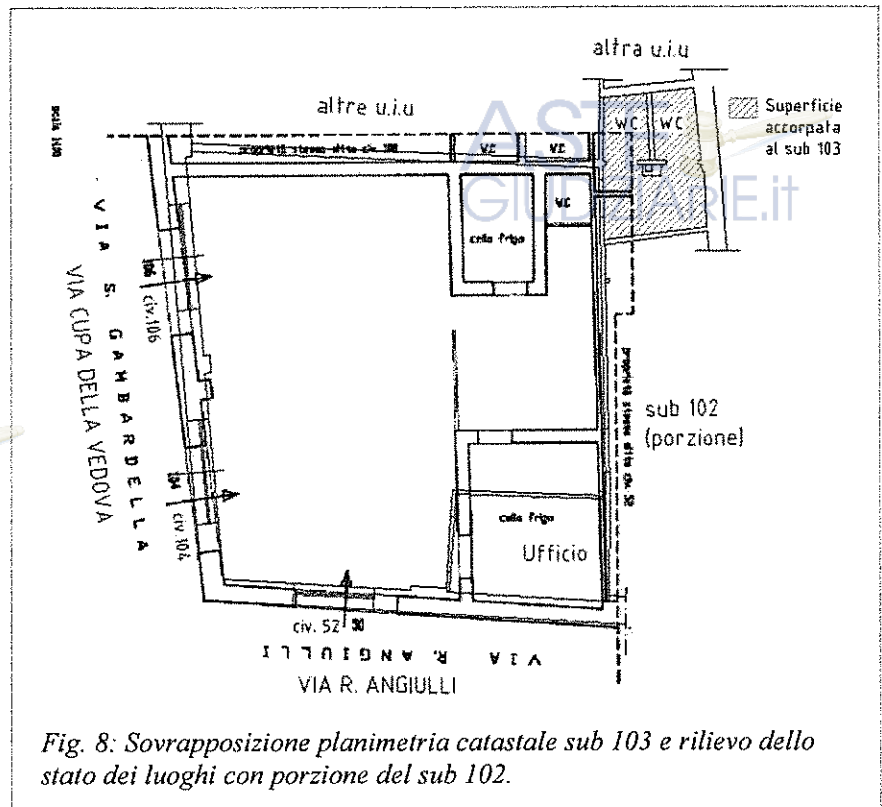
Sovrapposizione planimetria catastale sub 103 e rilievo dello stato dei luoghi con porzione del sub 102.
